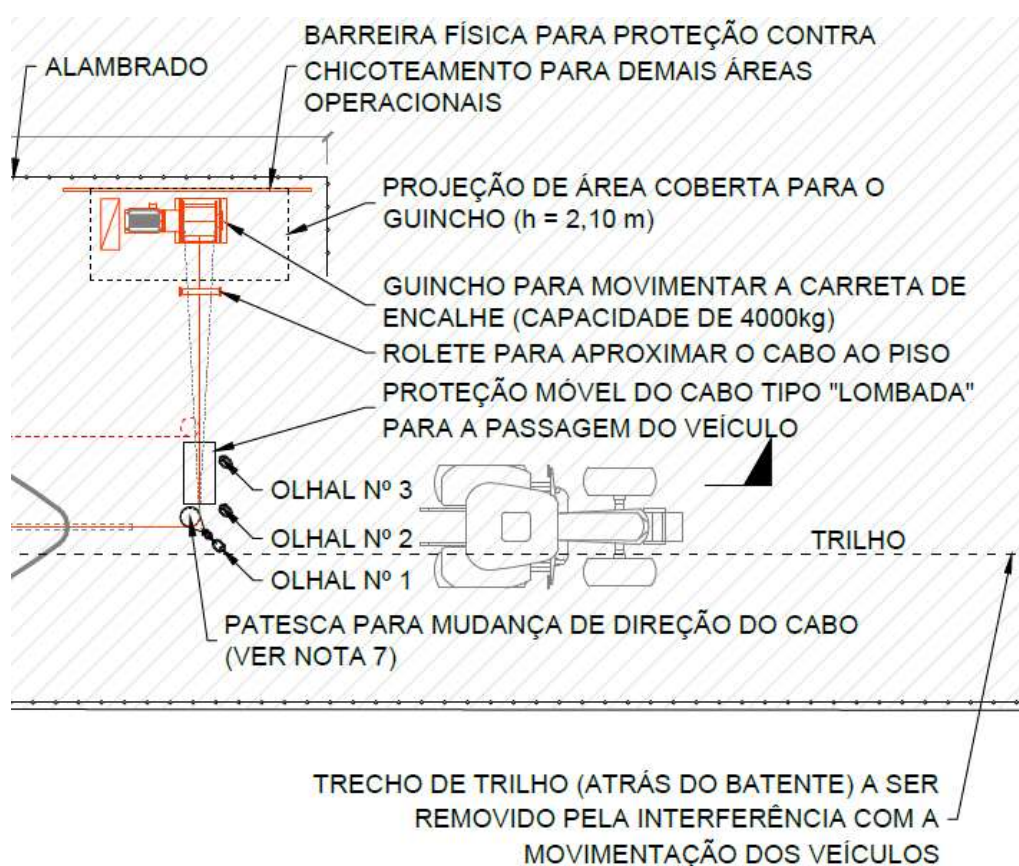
Instalações e guincho para retirada/lançamento de embarcações
